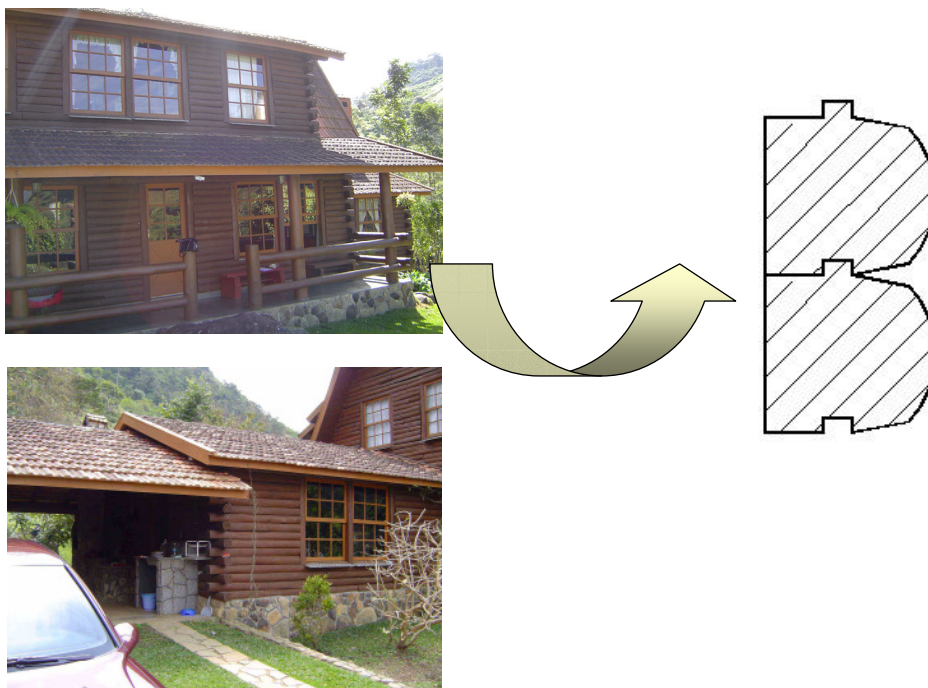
1: Vista geral da casa em Piaçu e detalhe do encaixe das toras
